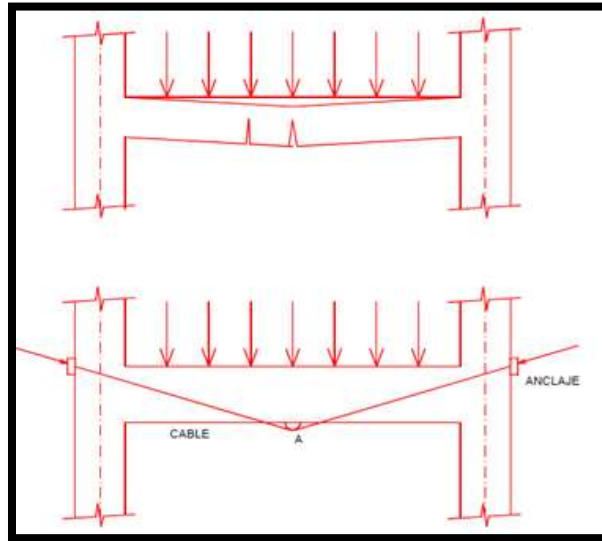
Recuperación y refuerzo de una viga dañada.
